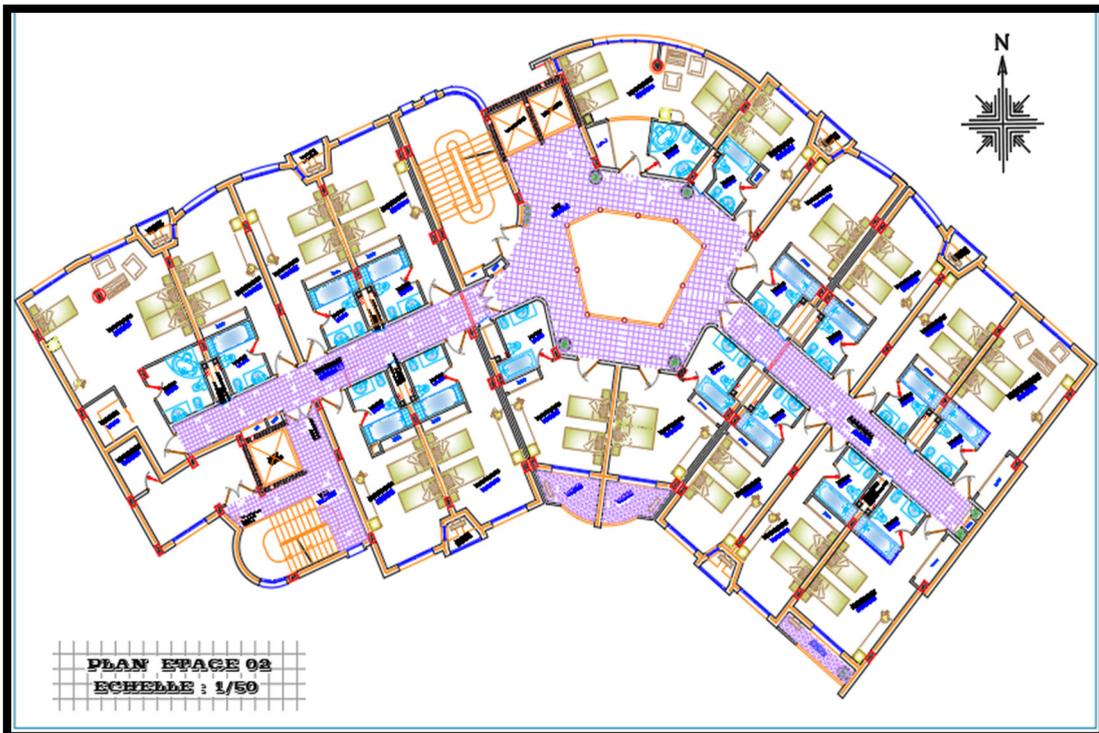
Plan étage 02,03 et 04 du cas d'étude.
